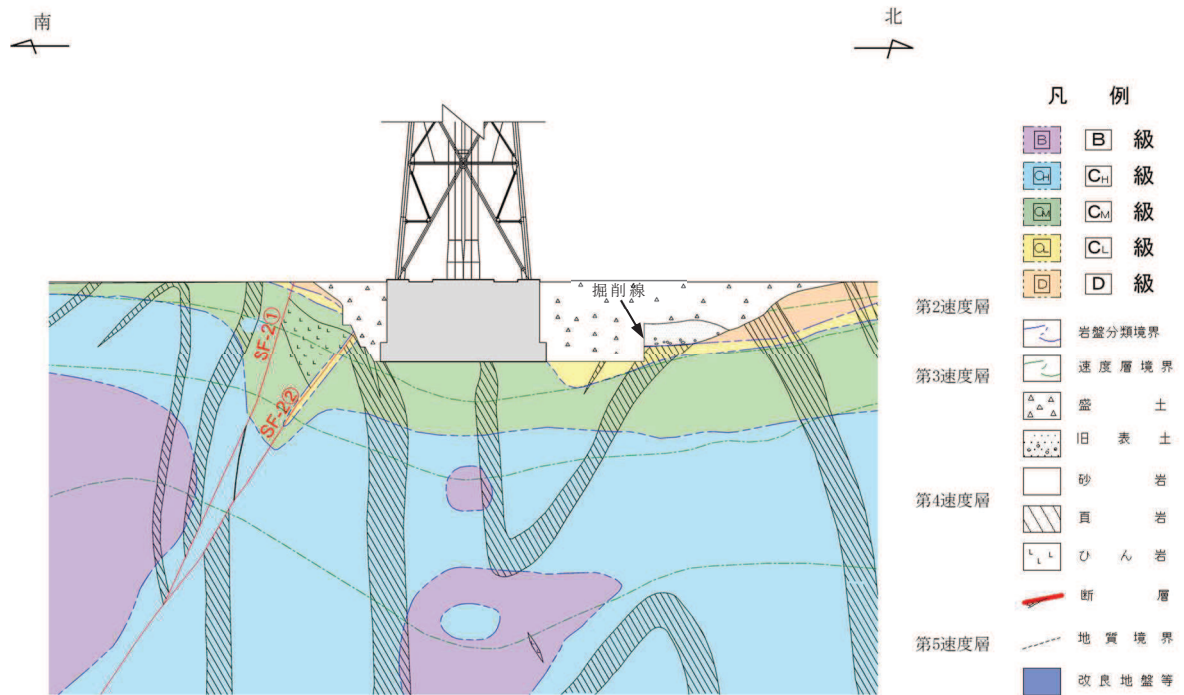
排気筒の地質断面図 (⑤-⑤断面)
